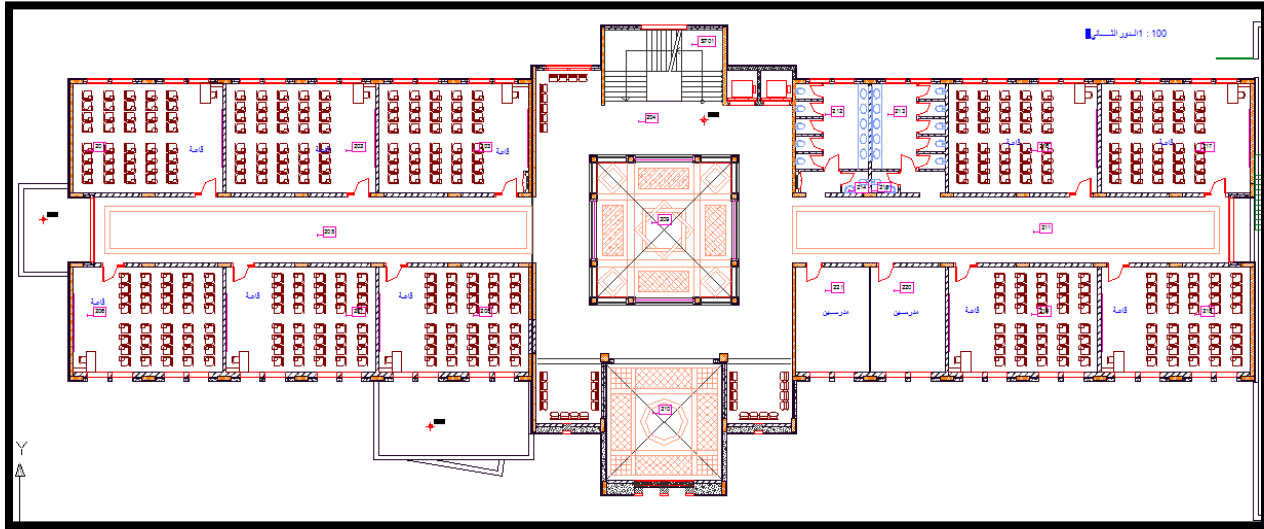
المسقط الأفقي للطابق الأول.
